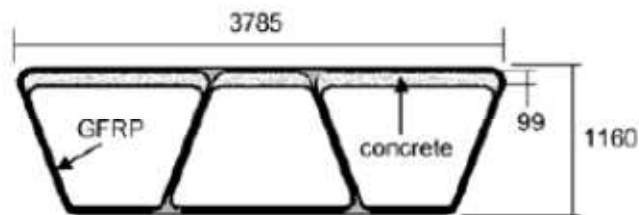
Estructura, sección vigas. (Aref et al., 2005)
